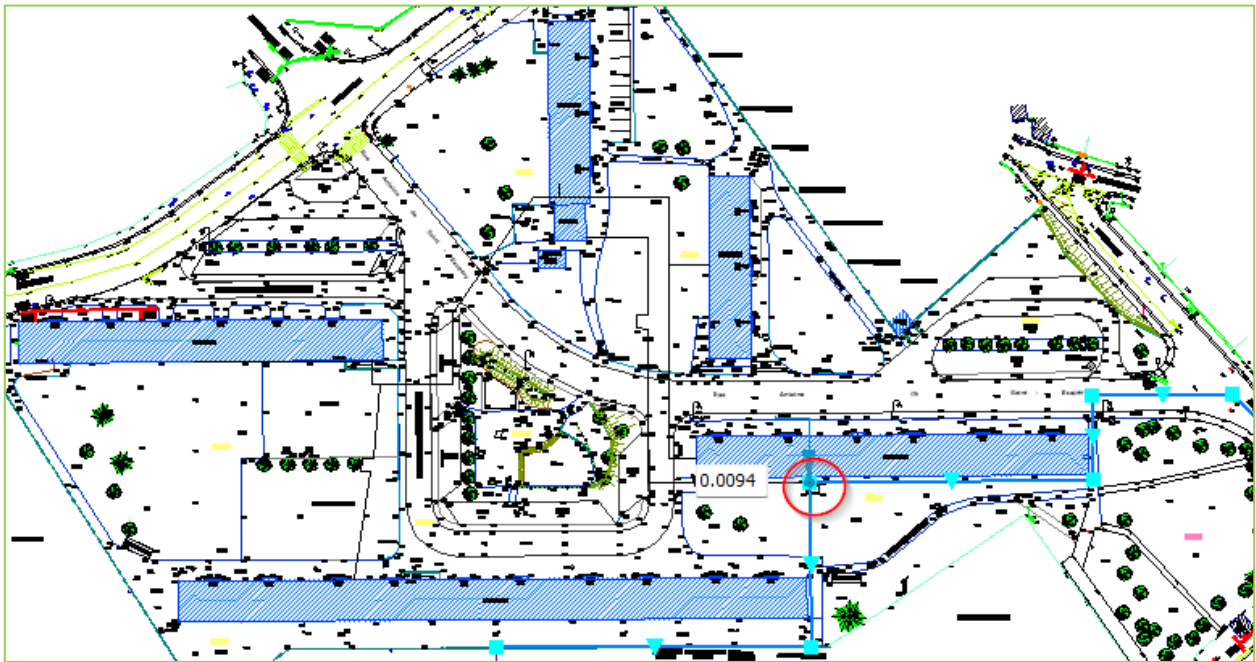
PLAN DU RESEAU DE CHALEUR SUR LE SITE
